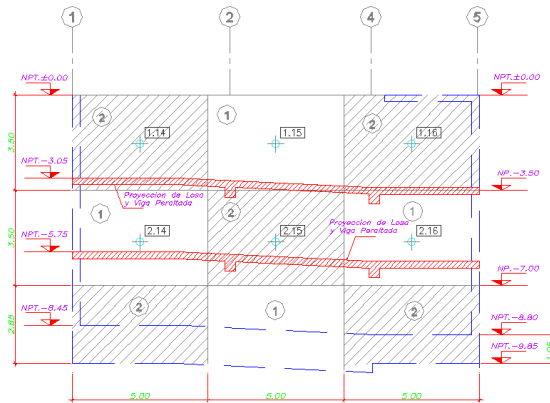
Muro Anclado - Proyección de Losa y Vigas Peraltadas en "Eje A".
